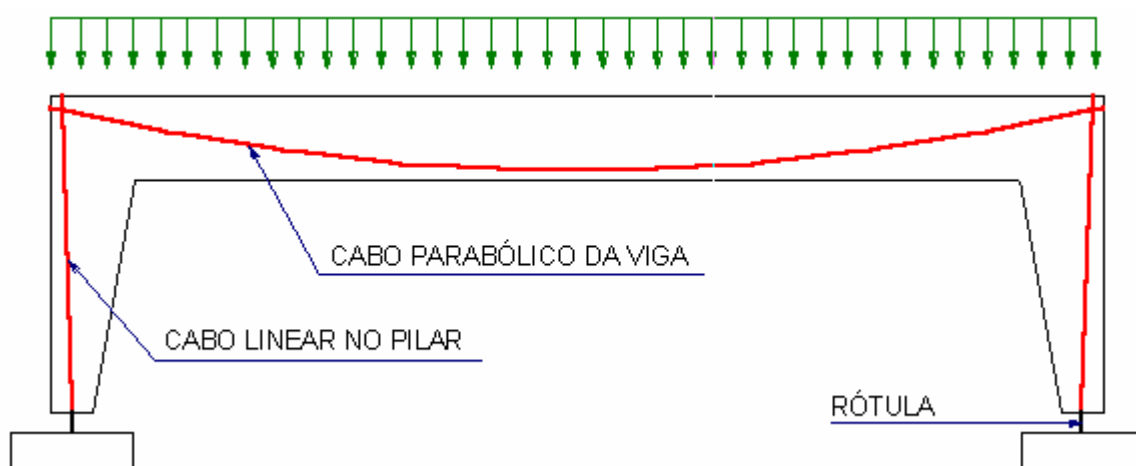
Pórtico Protendido – Nilson (1987)
